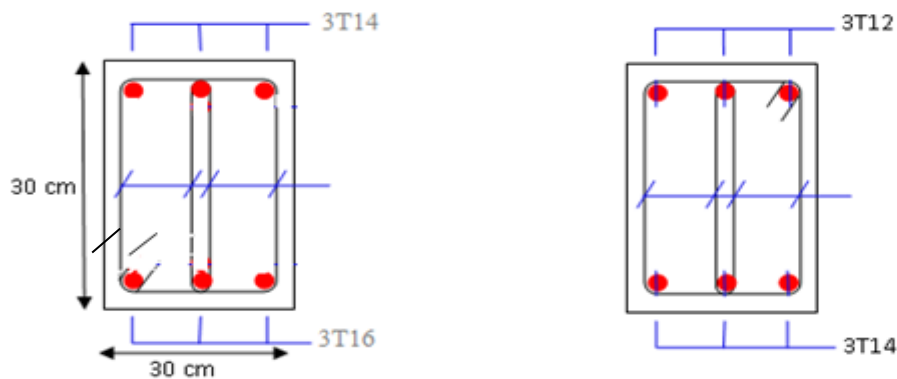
Ferrailage des poutres secondaires (30x30)
